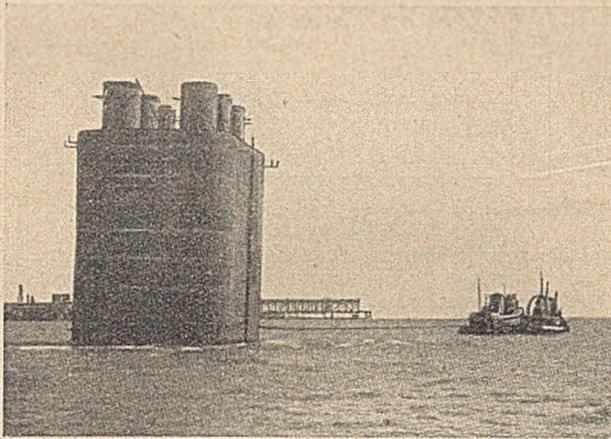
Der 96 km weite Transport des Senkkastens von der Werkstatt bis zur Baustelle dauerte 60 Stunden. Etwa 600 m<sup>3</sup> Beton waren vorher an der Schneide eingebracht worden, um den Caisson aufrecht schwimmen zu lassen und ihm einen Tiefgang von 10 m zu geben.
